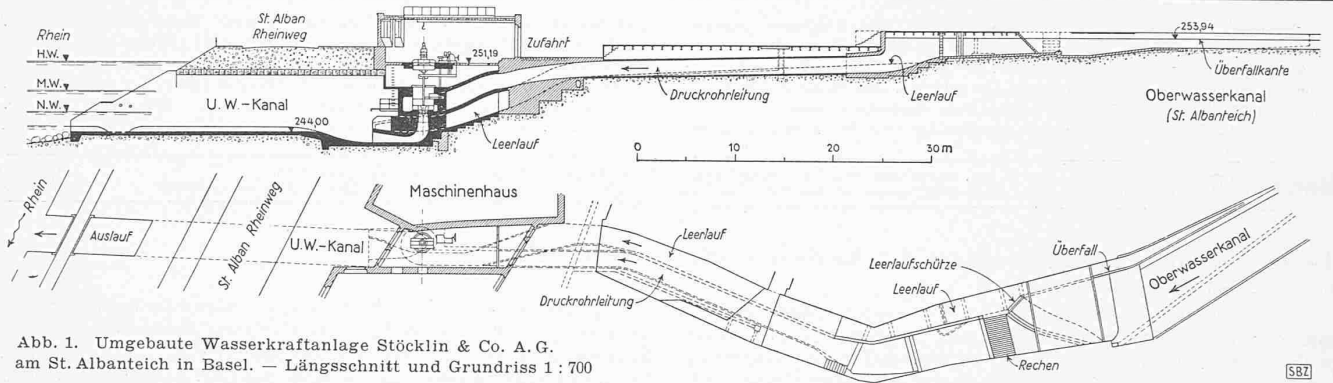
Umgebaute Wasserkraftanlage Stöcklin & Co. A.G. am St. Albenteich in Basel. — Längsschnitt und Grundriss 1 : 700
